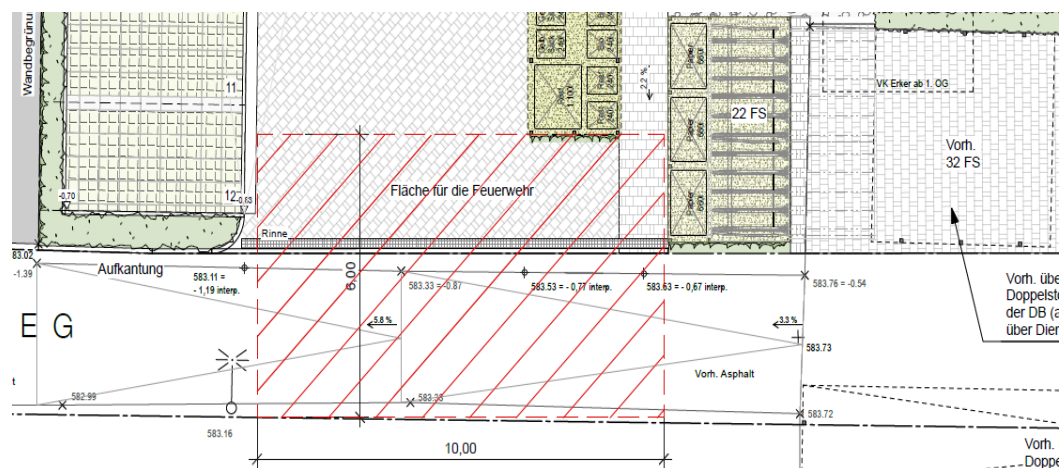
Fläche für die Feuerwehr, ohne Maßstab, Quelle: BHB
